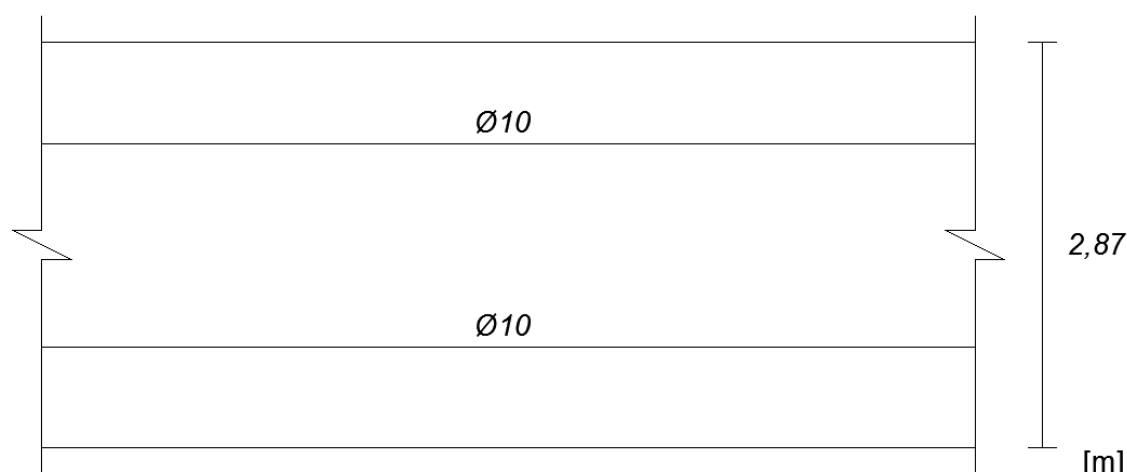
Pormenorização das armaduras de pré-esforço longitudinal da laje em planta (Marques, J. 2013)
